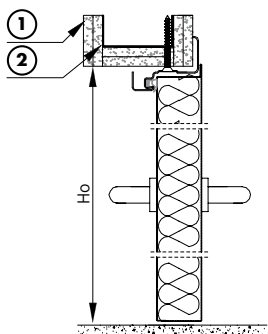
Montage mural d'un bloc-porte à un battant avec bâti angulaire - coupe verticale
